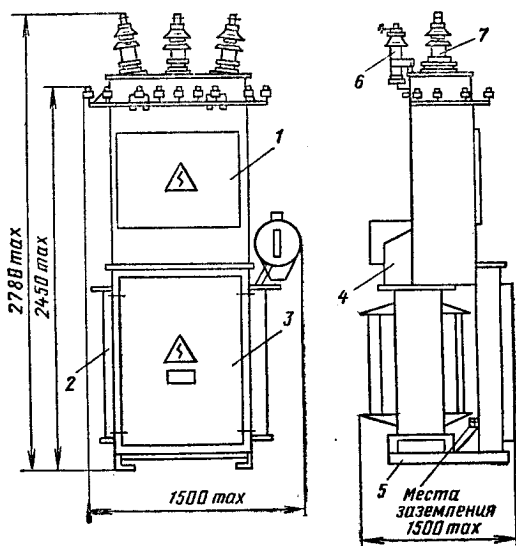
Внешний вид КТП-630-2500 при двухрядном расположении
